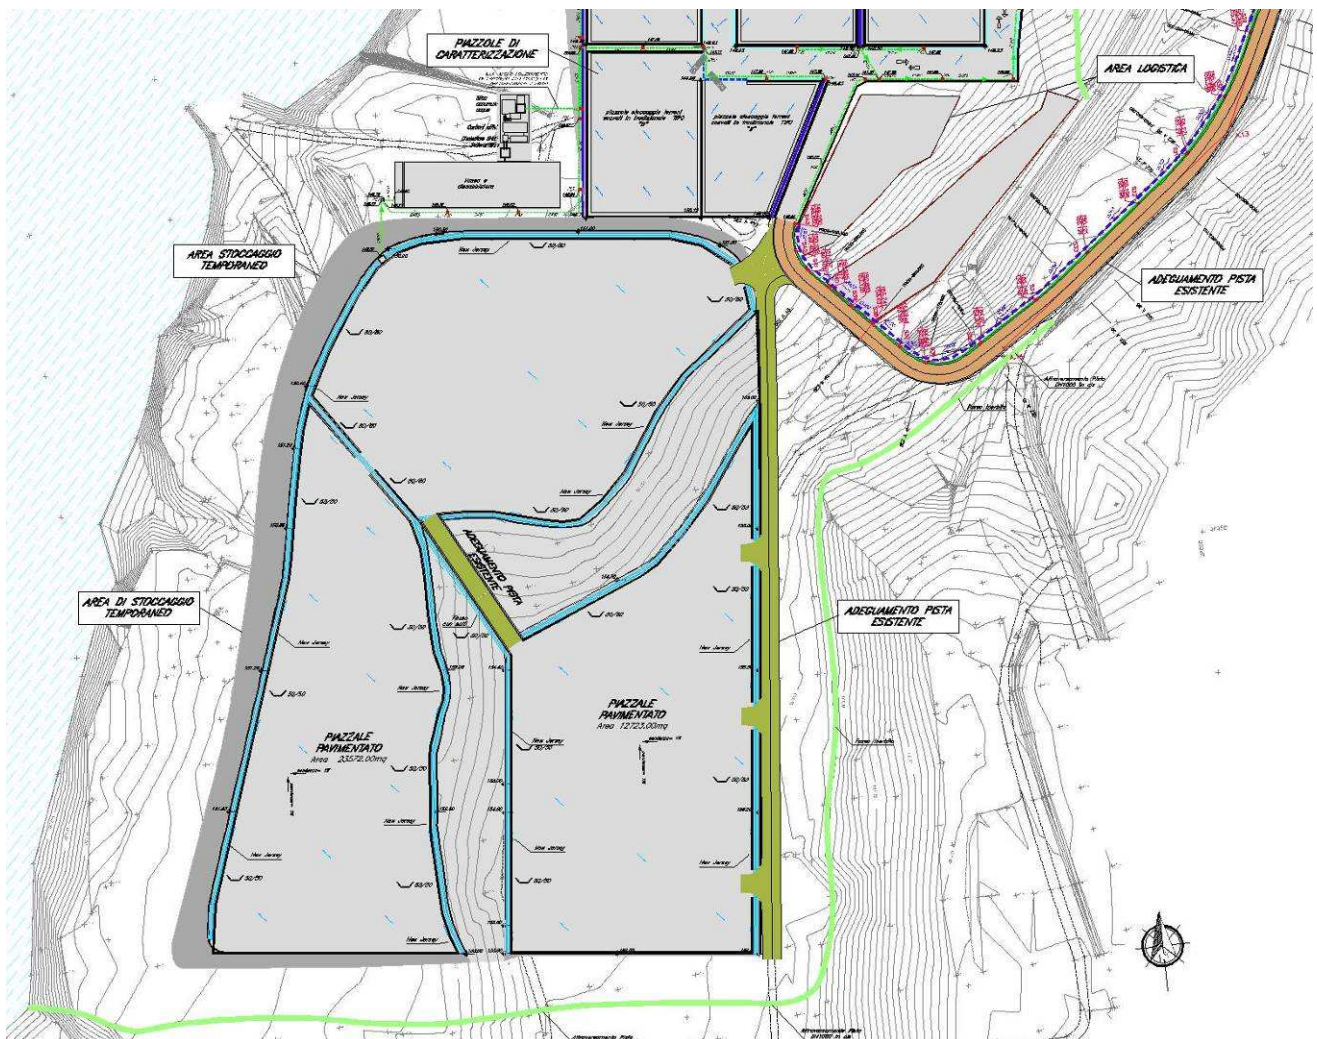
Planimetria idraulica Area di stoccaggio temporaneo
